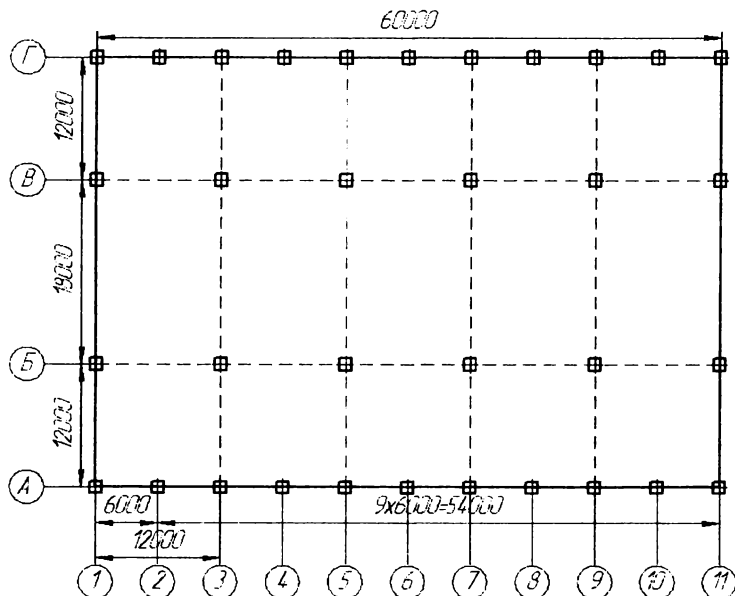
Нанесение размеров и координационной сетки на чертеже плана производственного корпуса (обозначены места установки колонн)
